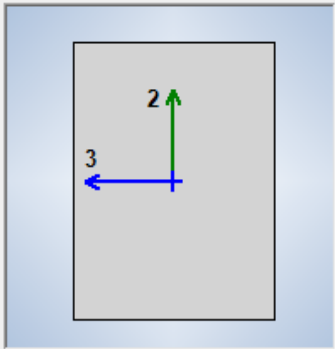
Sección transversal de las columnas 30x40cm. Fuente: Propia
